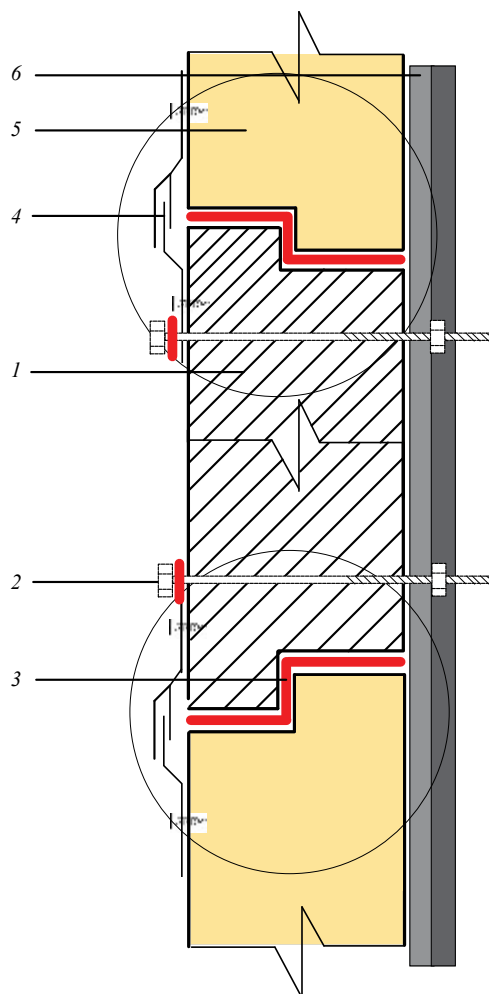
, а. Вид проекта ЛССП со ступенчатой системой термоизоляции: 1 — легкосбрасываемая сэндвич-панель; 2 — разрушаемый узел крепления; 3 — легкосъемное крепление; 4 — термоизоляционная подушка; 5 — защитная планка; 6 — стеновая панель
